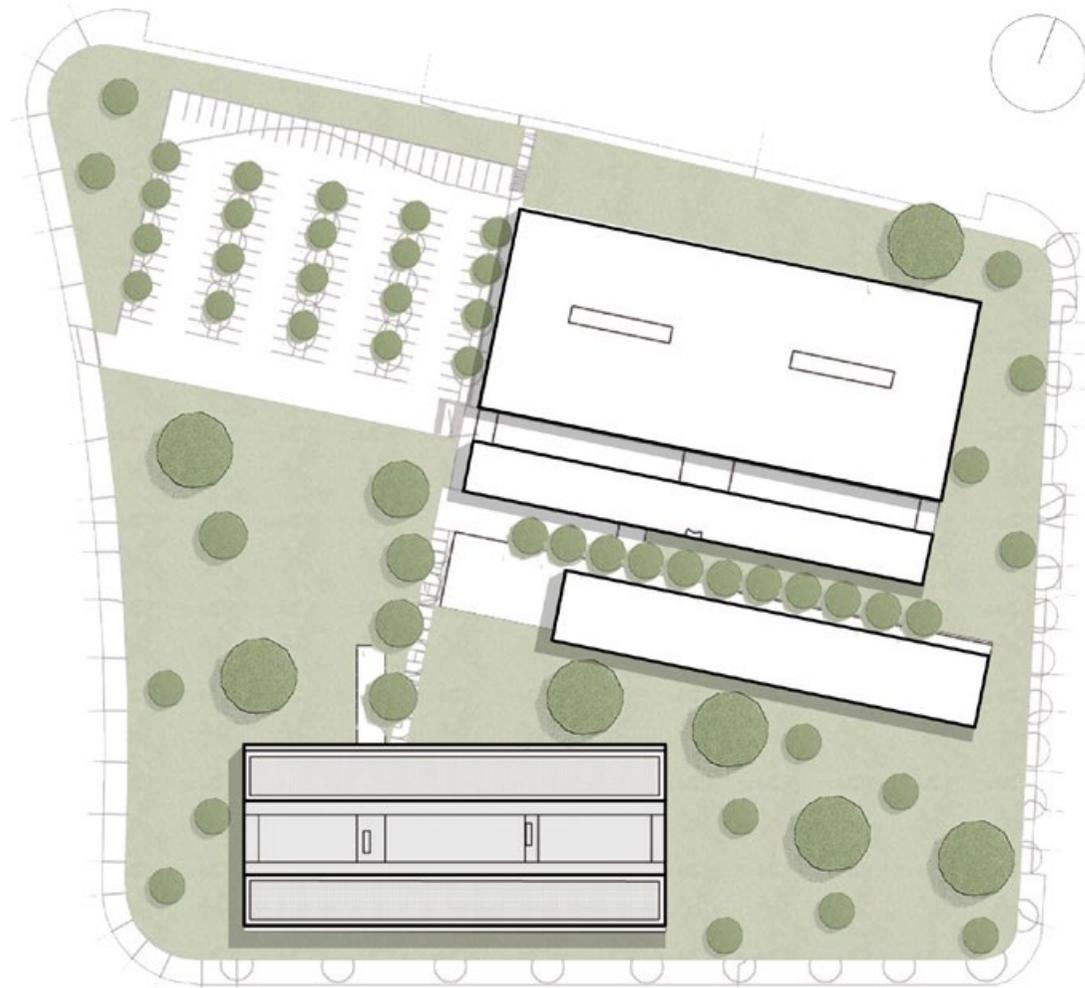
Emplazamiento 1:1000. Fuente: Archdaily, 2011, editado por autores.
